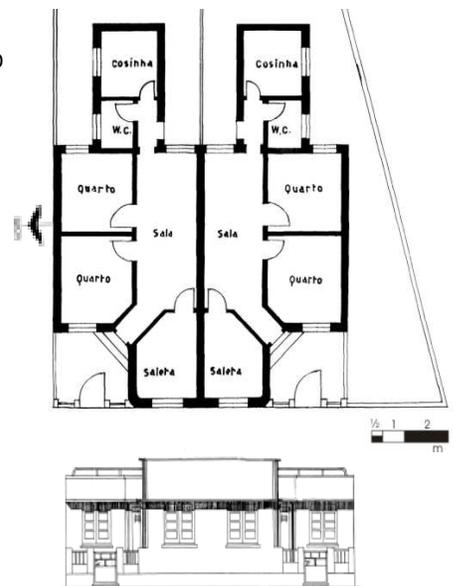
Casas Pedro Alcântara (1953), de Cassiano Fernandez. Planta Baixa e fachada.
